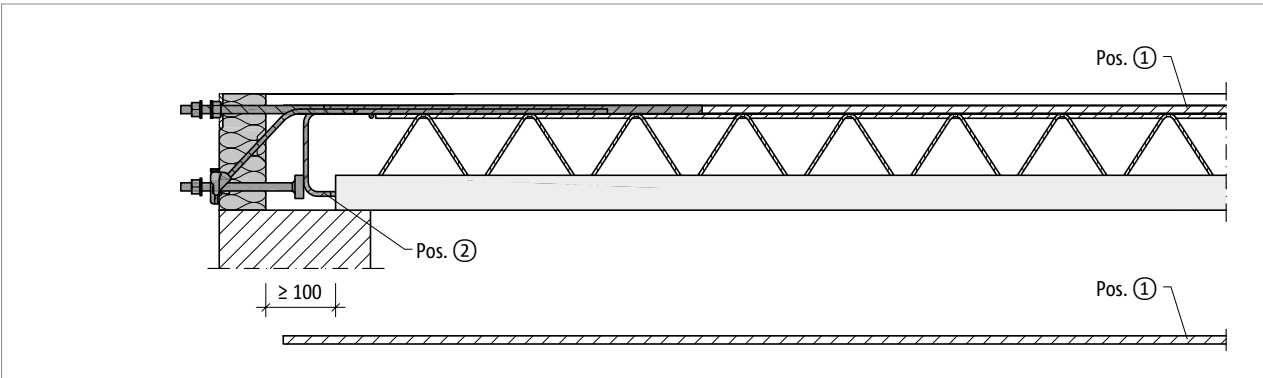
Schöck Isokorb® T Typ SKP-M1: Bauseitige Bewehrung bei Halbfertigteilbauweise, Schnitt
